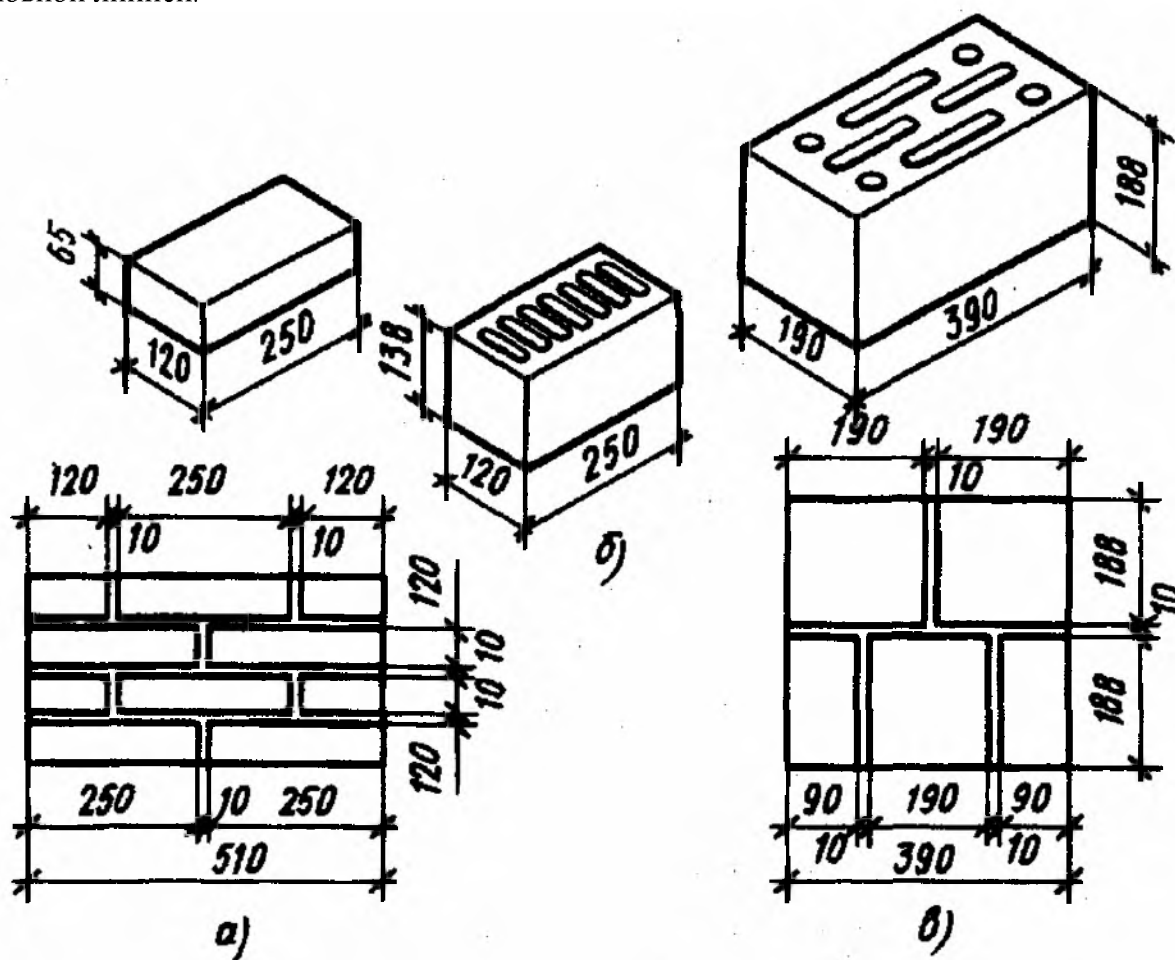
Керамический кирпич и кладка из него (а), керамический камень с семью вертикальными щелевидными пустотами (б) и легкобетонный камень с щелевидными пустотами и кладка из него (в)
